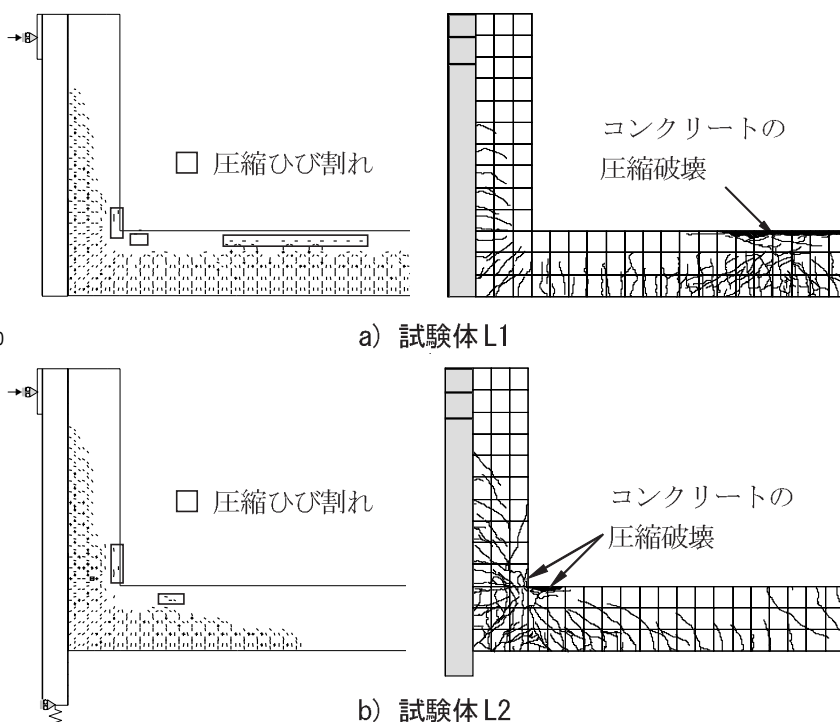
ひび割れ発生状況（左：解析，右：実験）
